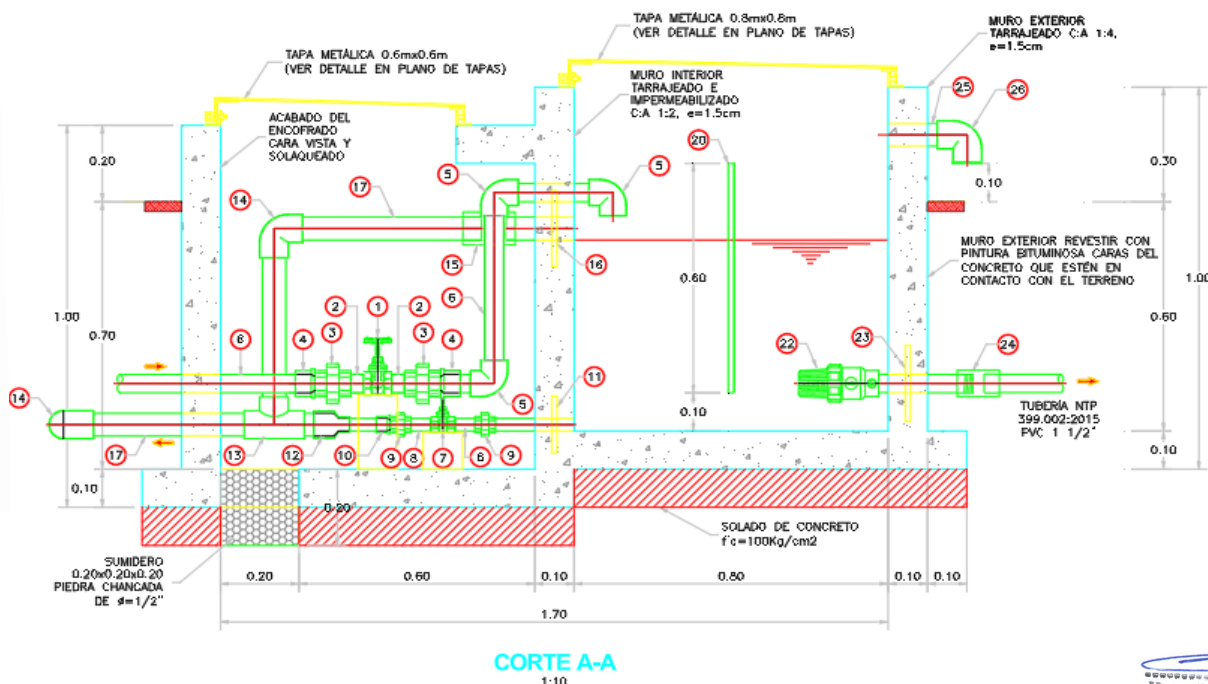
Sección A-A Cámara Rompe Presión Tipo 6
